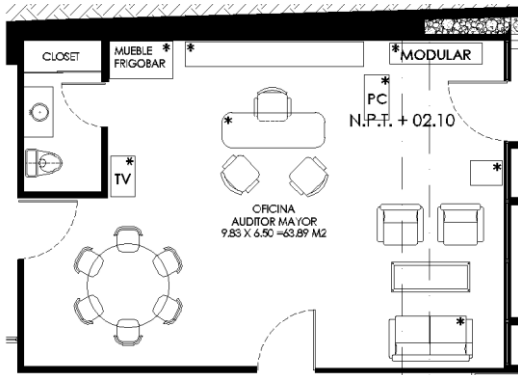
Vista en planta de Oficina de Auditor Mayor.
